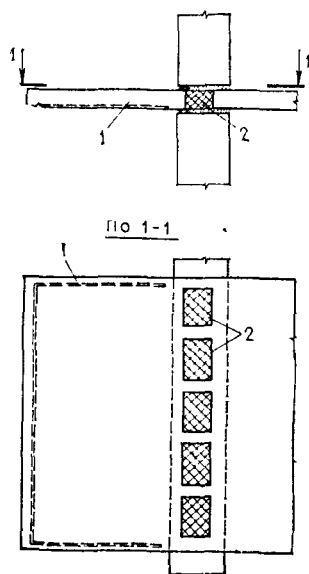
Утепление зоны сопряжения балконной консоли перекрытия с наружной стеной
